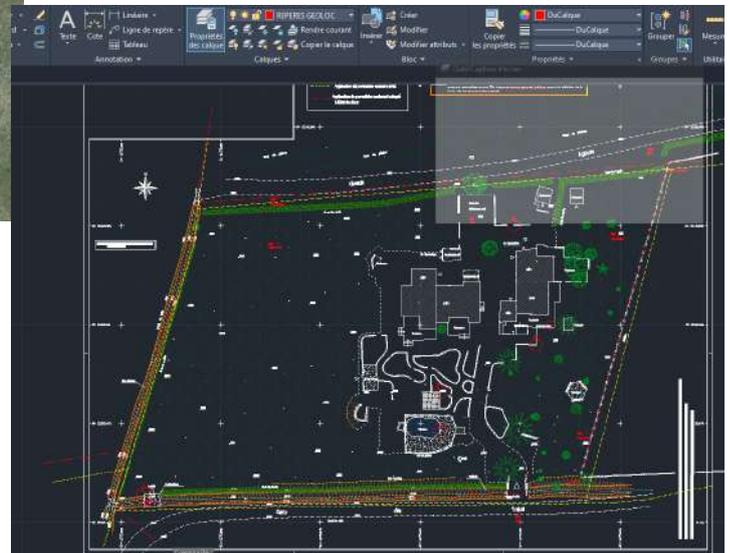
Baustellenplan, der mit dem skalierten Orthomosaik in Autocad erstellt wurde
